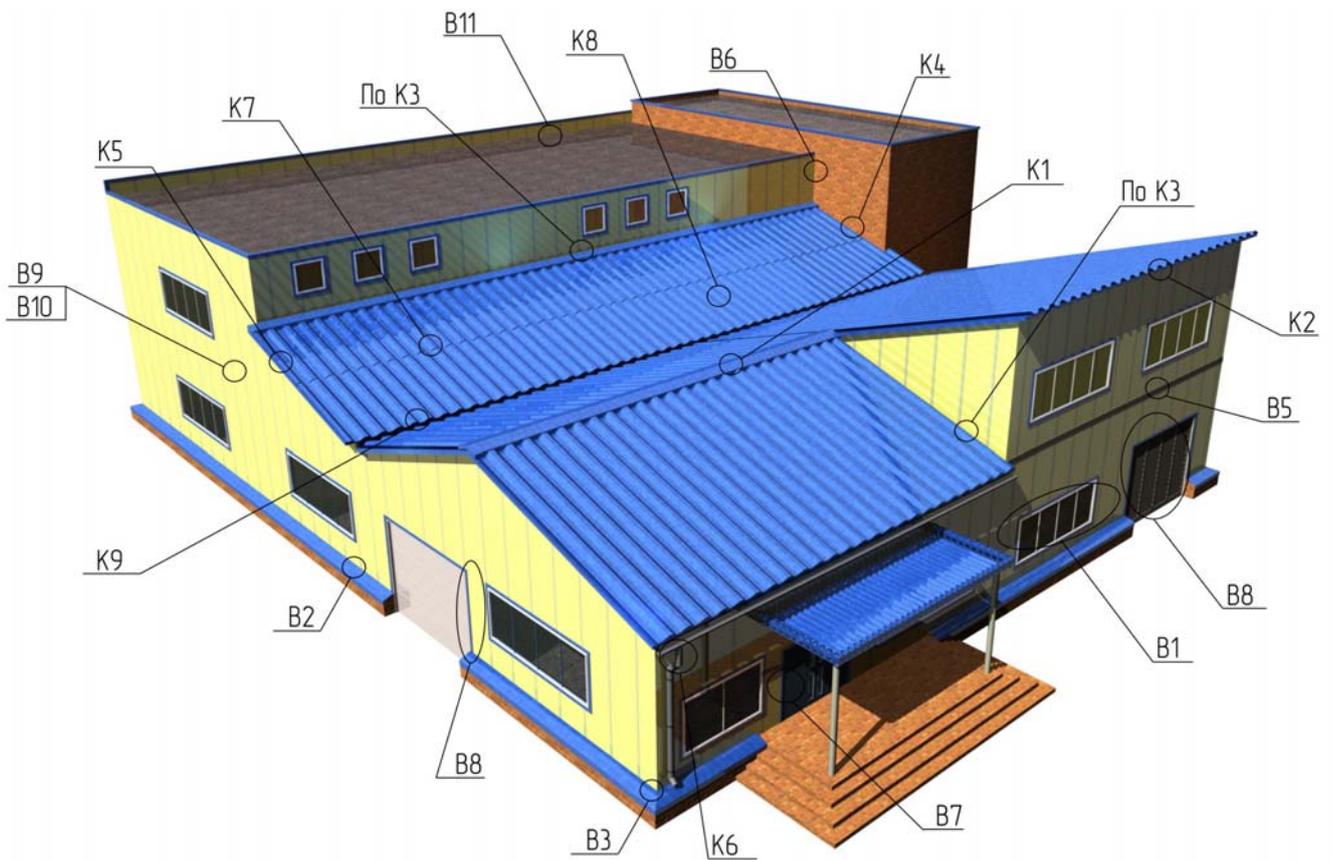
а – Здание с вертикальной раскладкой стеновых панелей.
